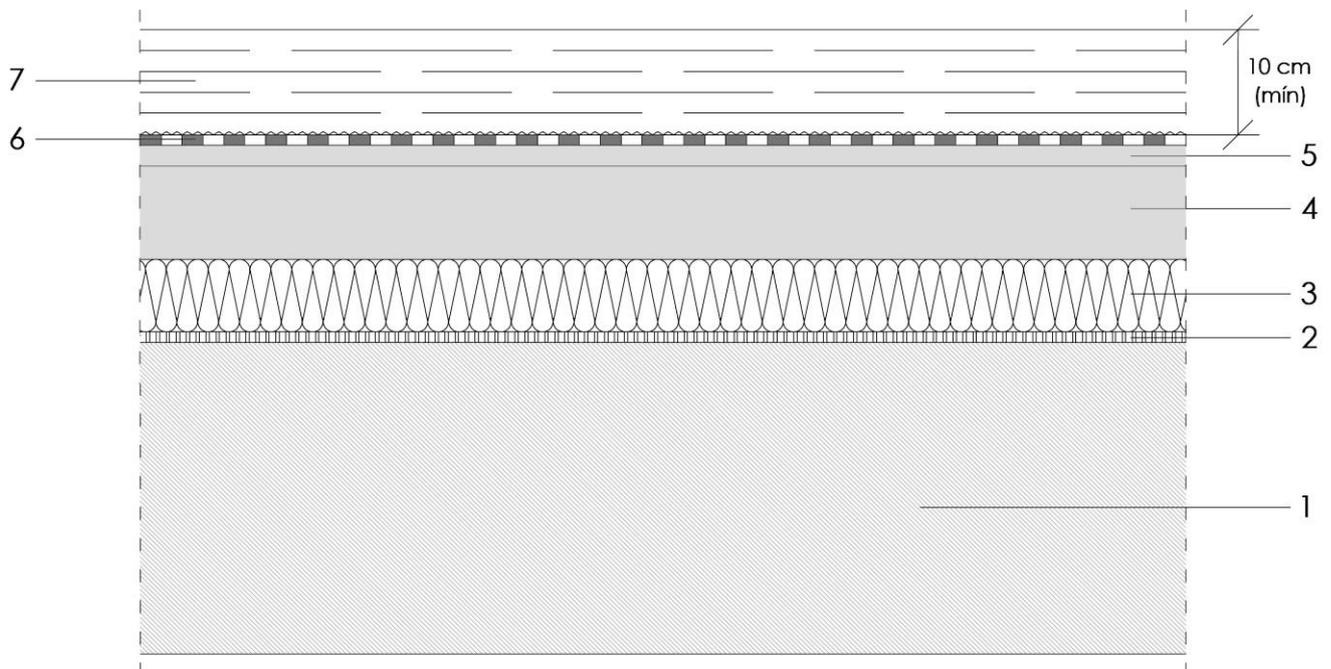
Detalle constructivo de cubierta inundada convencional no transitable.
